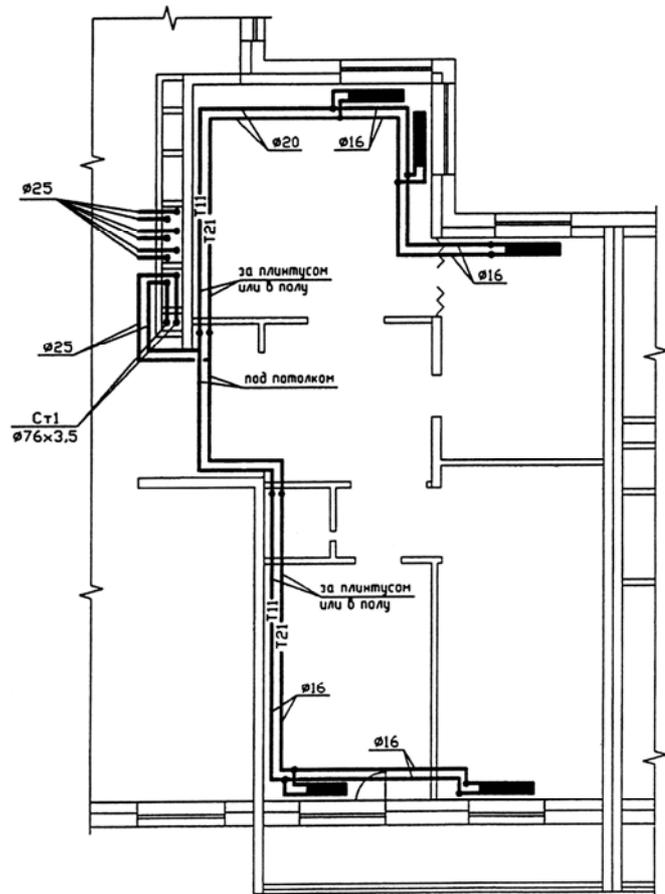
Система отопления с плинтусной разводкой теплопроводов по квартире
